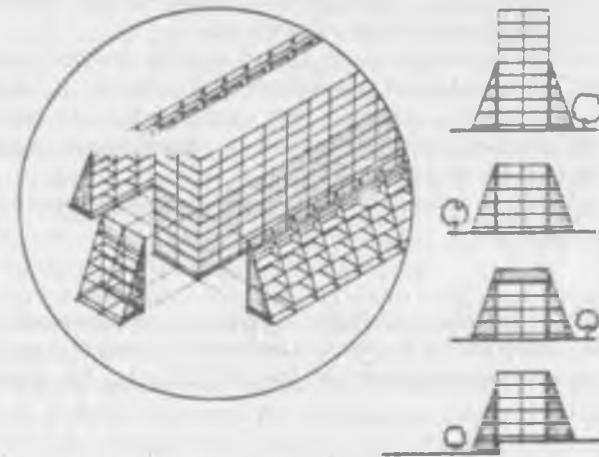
Изображение конструкций в сечениях зданий промышленных зданий (конструкции)
